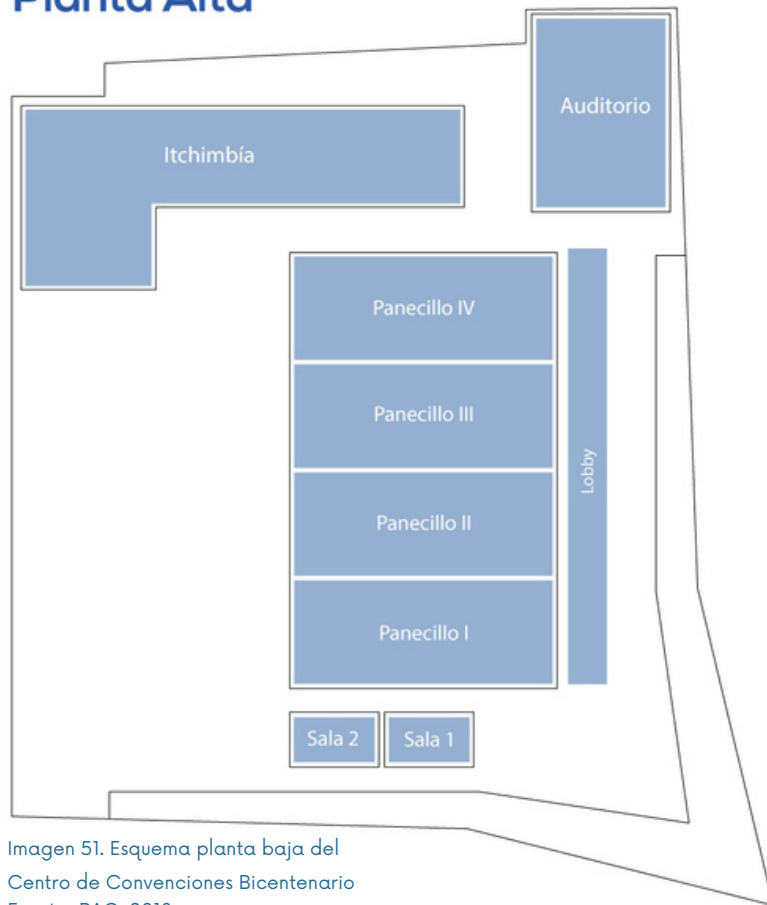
Esquema planta baja del Centro de Convenciones Bicentenario
